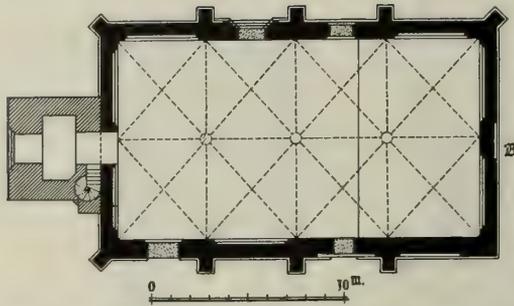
Wittstock, Grundriß der Heiliggeistkirche.
